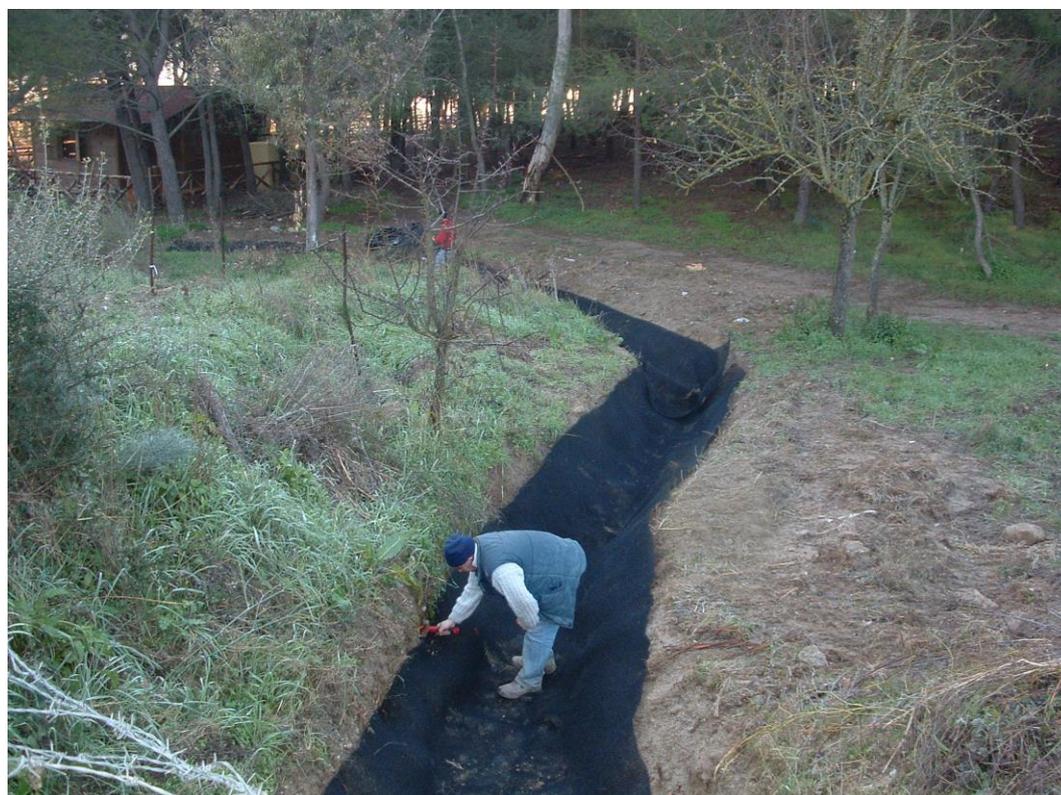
Sistemazione antierosiva di un canale naturale con geostuoia.
